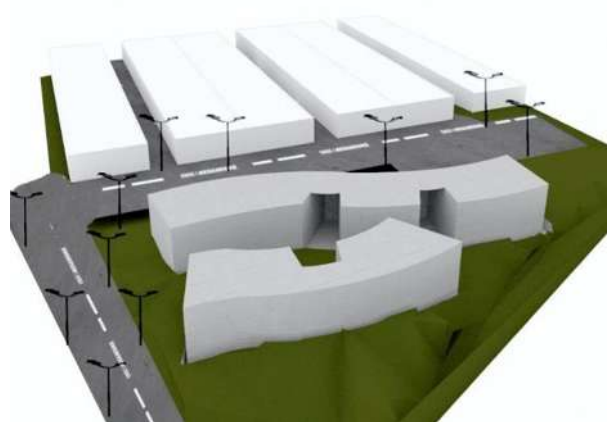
Infraestructura y equipamiento, Elaboró: R.H.M.A
